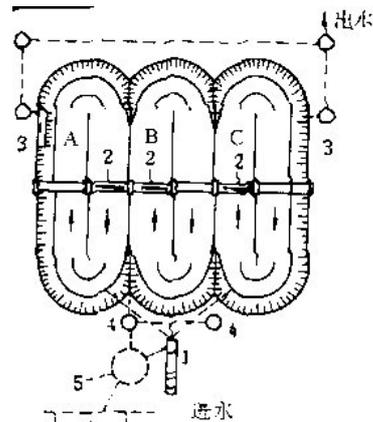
Grundriss einer Dreigräben-Art
